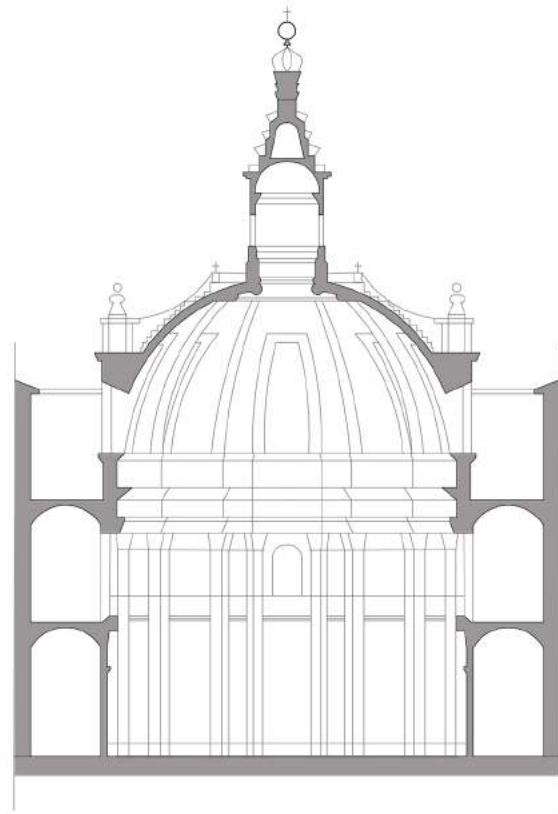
Sección esquemática de la iglesia Sant 'Ivo alla Sapienza, Borromi. Elaboración propia.
